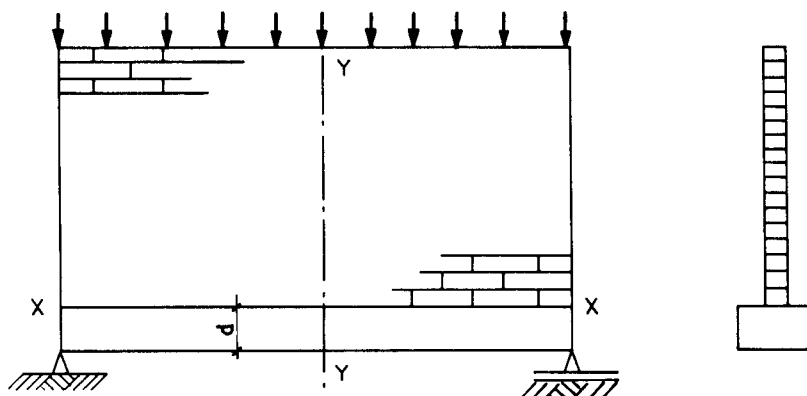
Parede sobre viga de apoio (Fonte: HENDRY [30]).
